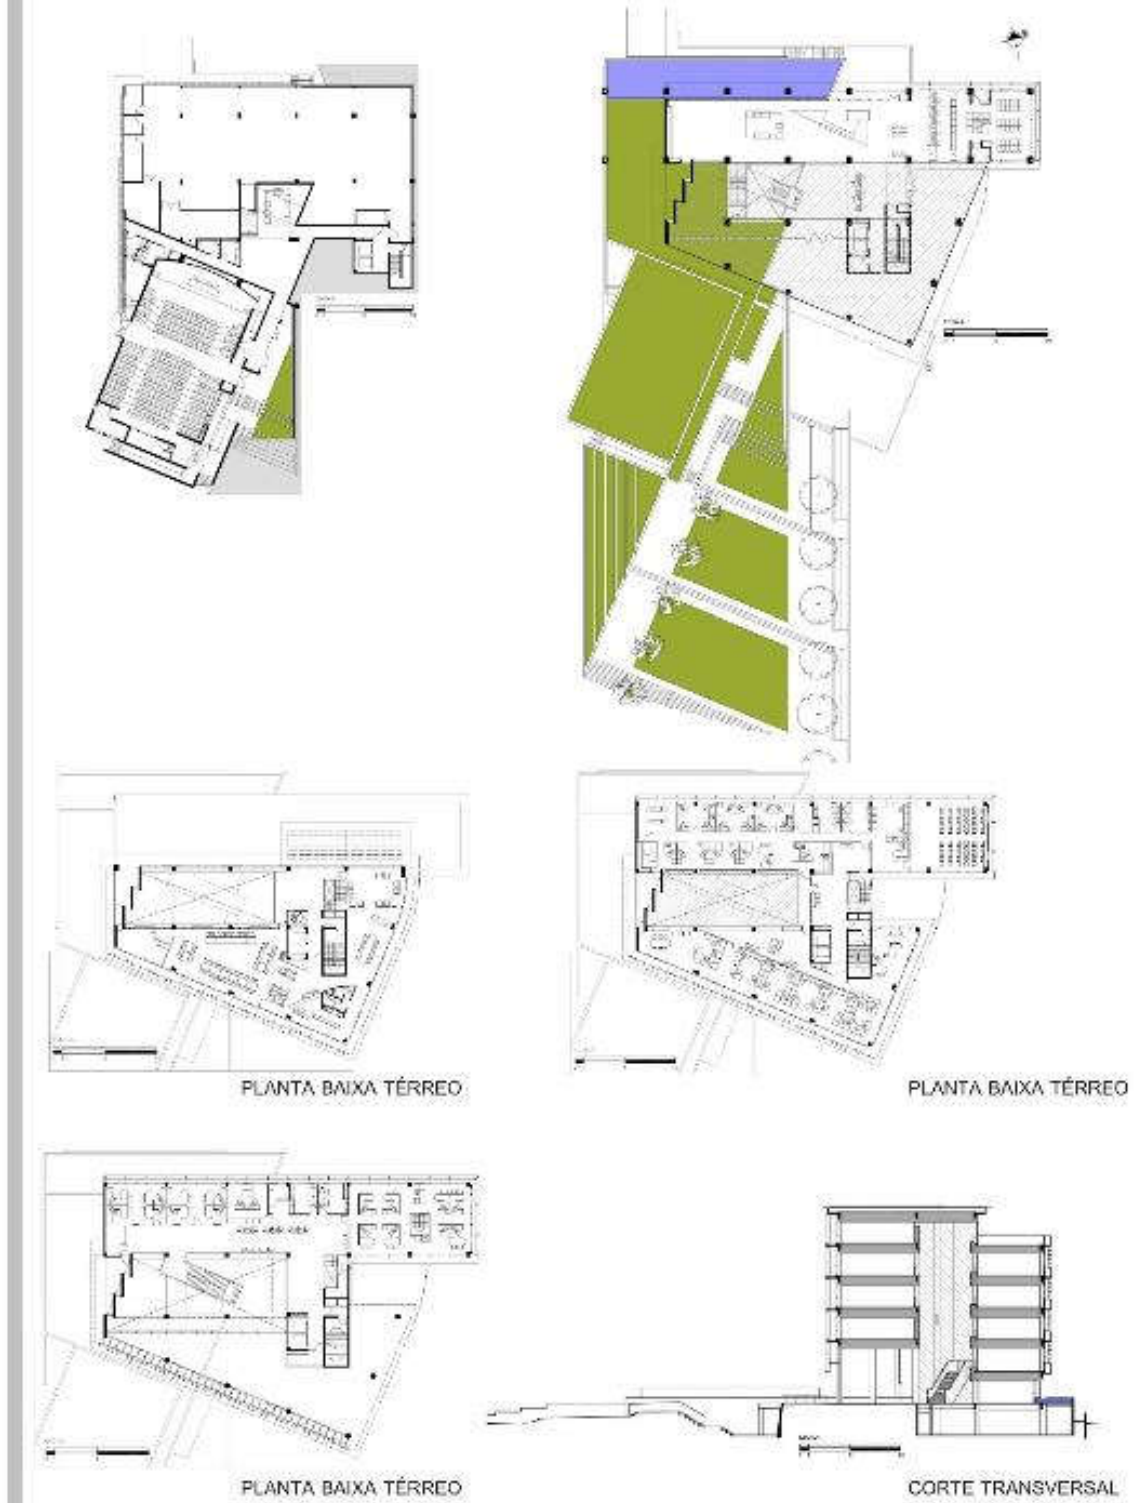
Topo à esquerda:* Planta Baixa Subsolo. *Topo à direita:* Planta Baixa Térreo. *Meio à esquerda:* Planta Baixa 6º andar. *Meio à direita:* Planta Baixa Tipo. *Base à esquerda:* Planta Baixa 2º andar. *Base à direita:* Corte Transversal.
